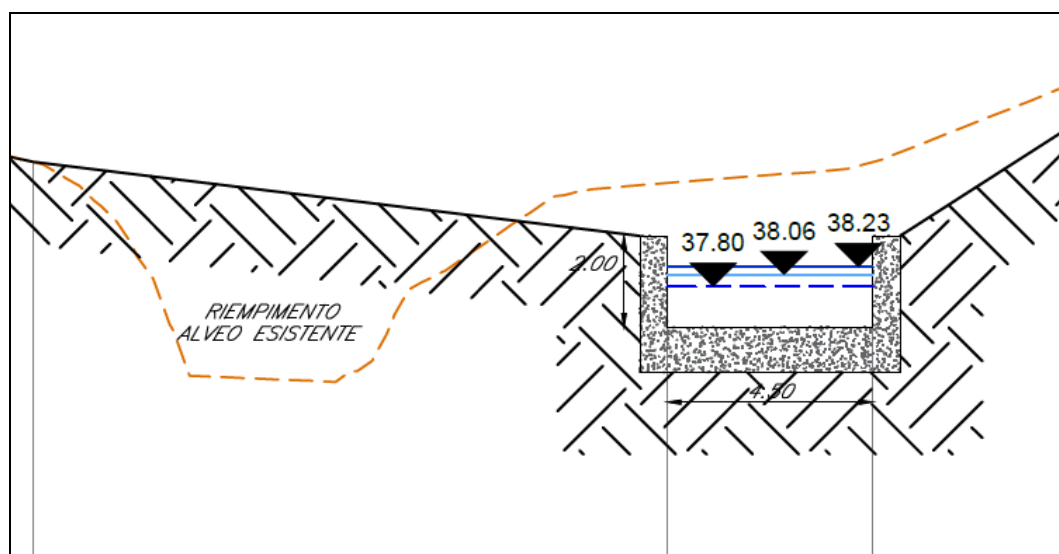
Pianta della sistemazione idraulica del Rio 81+972
